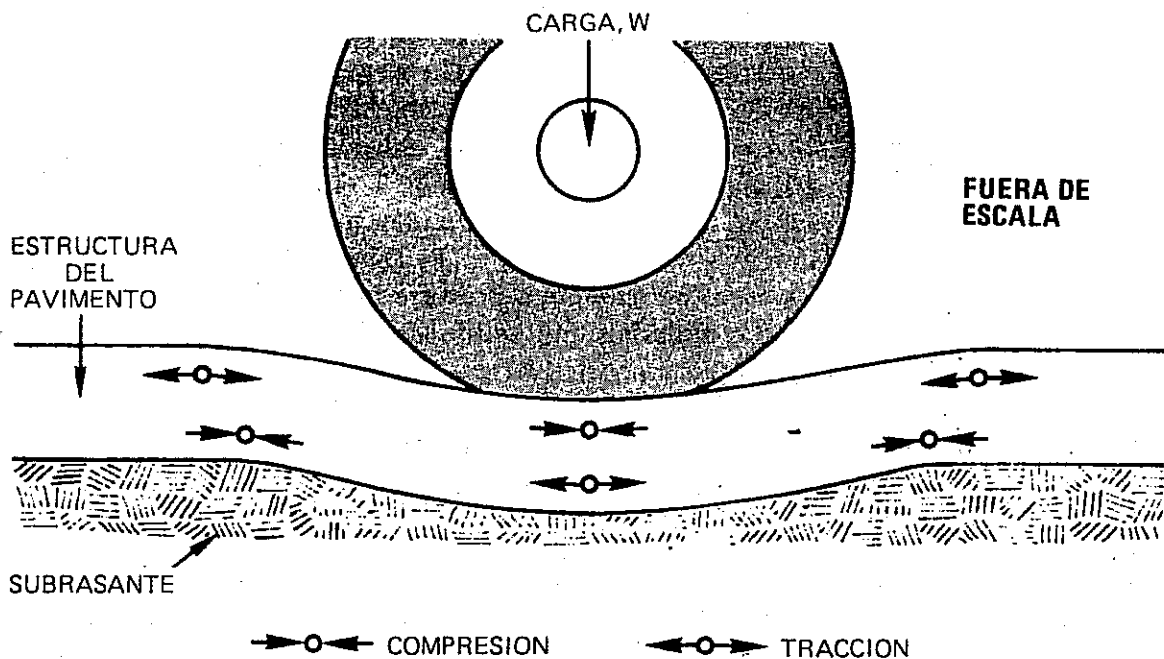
La deflexión debida a la carga de la rueda genera tensiones de tracción y de compresión en la estructura del pavimento
